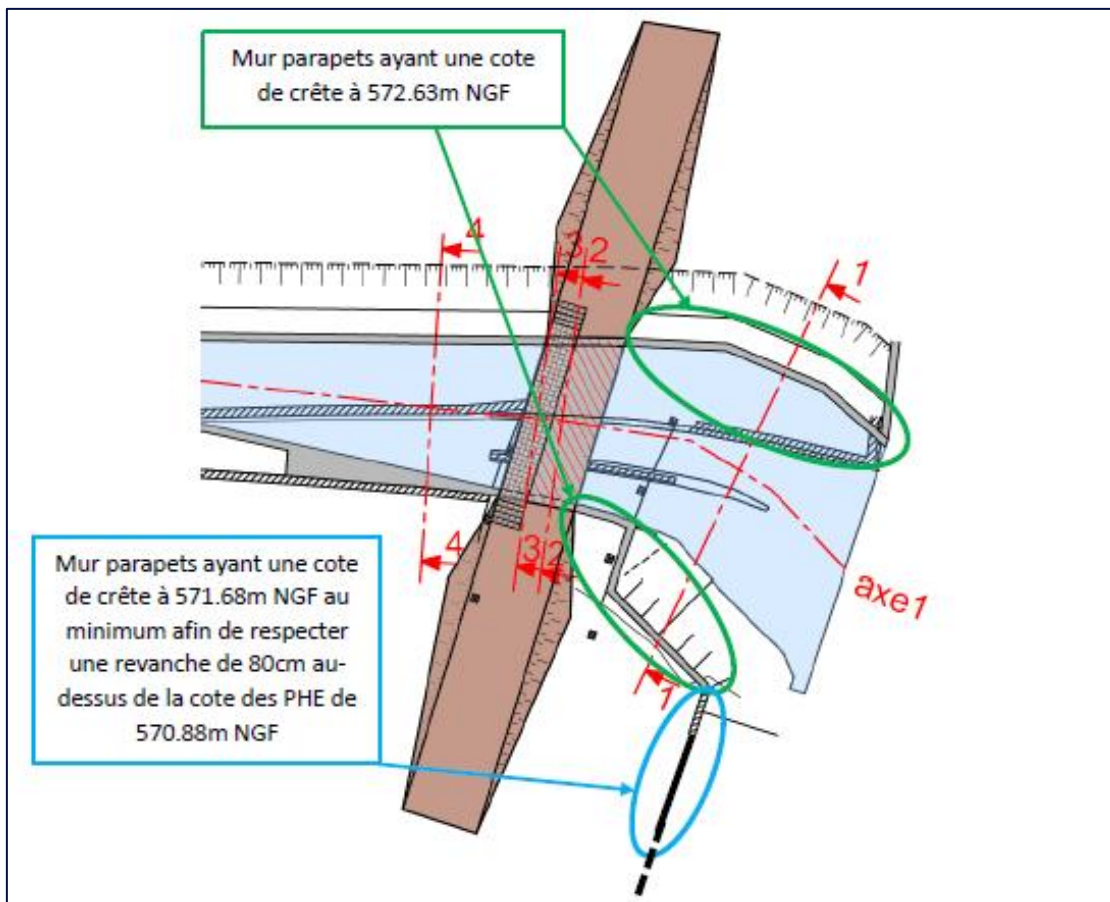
Cote de crête des murs parapets autour du convergent de l'EVC et le long du couronnement du barrage (Source : AVP)
